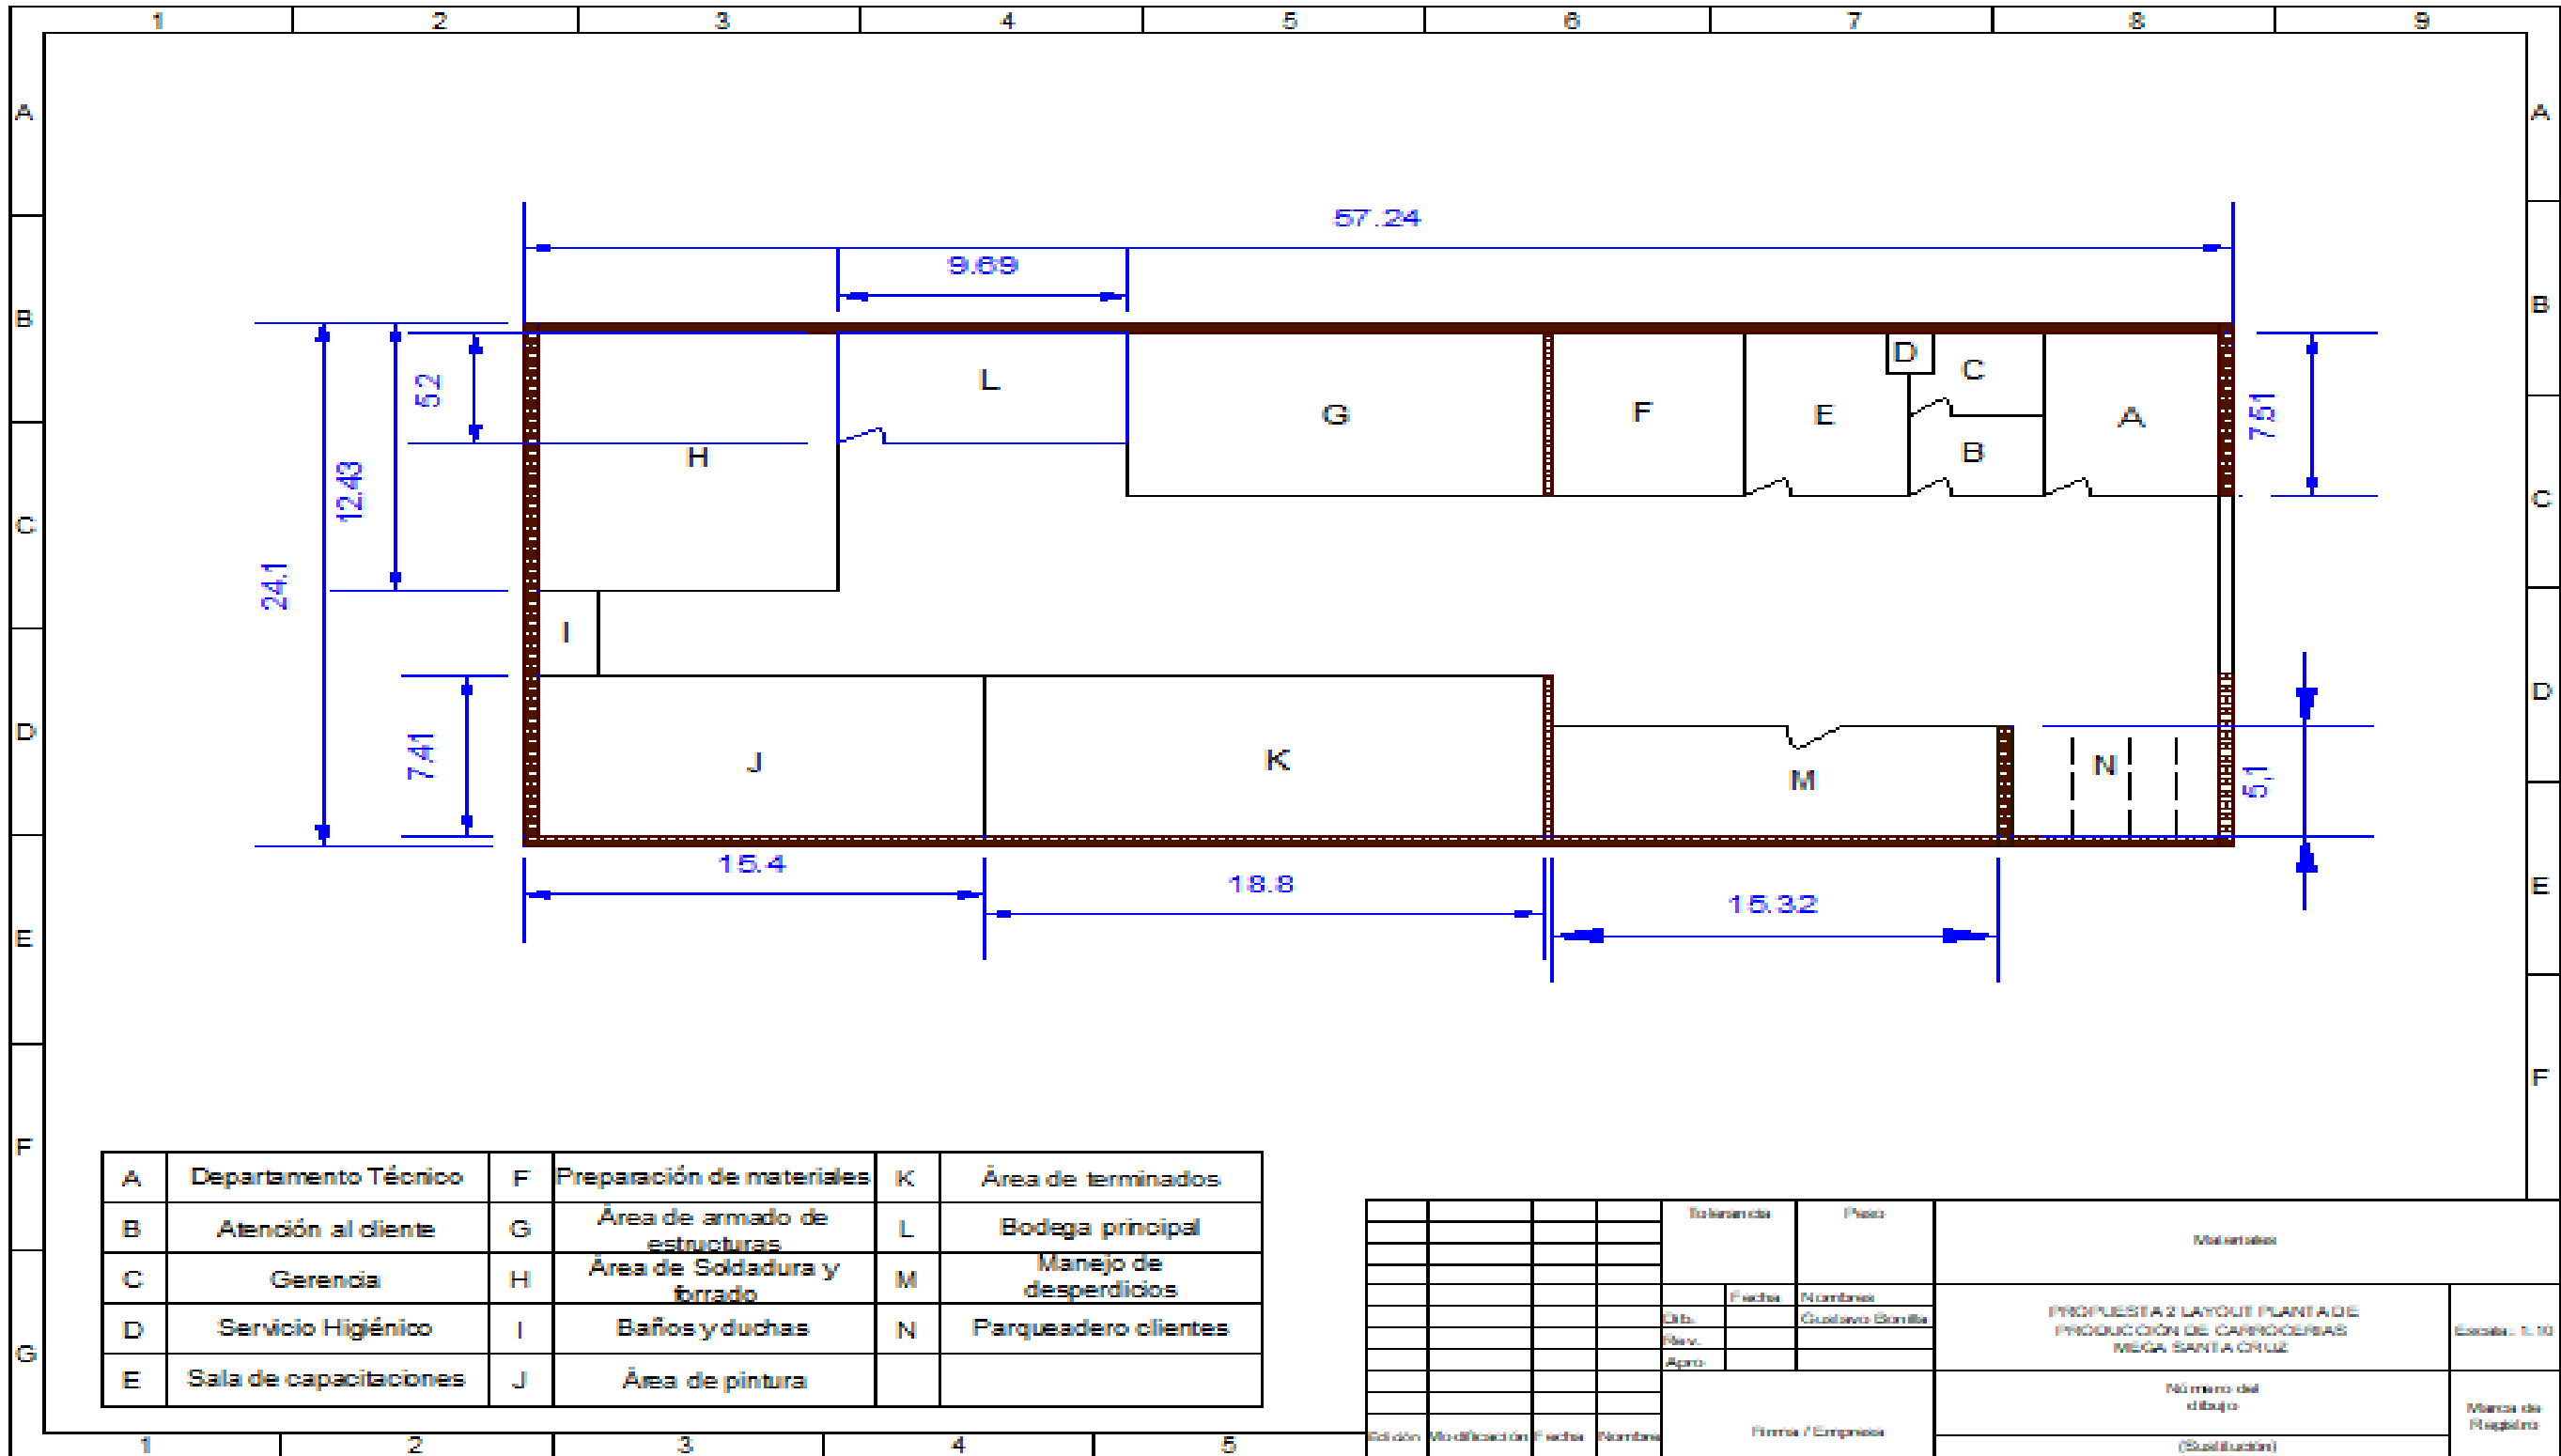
Áreas de la planta de Carrocerías Mega Santa Cruz (Propuesta 2)
